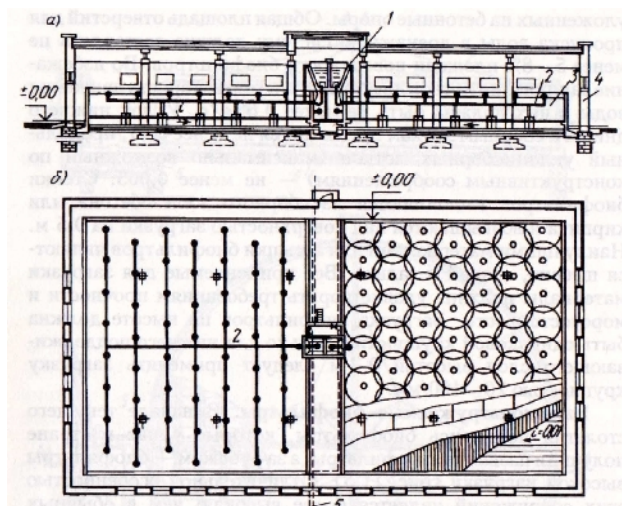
Капельный биофильтр: поперечный разрез и план;
